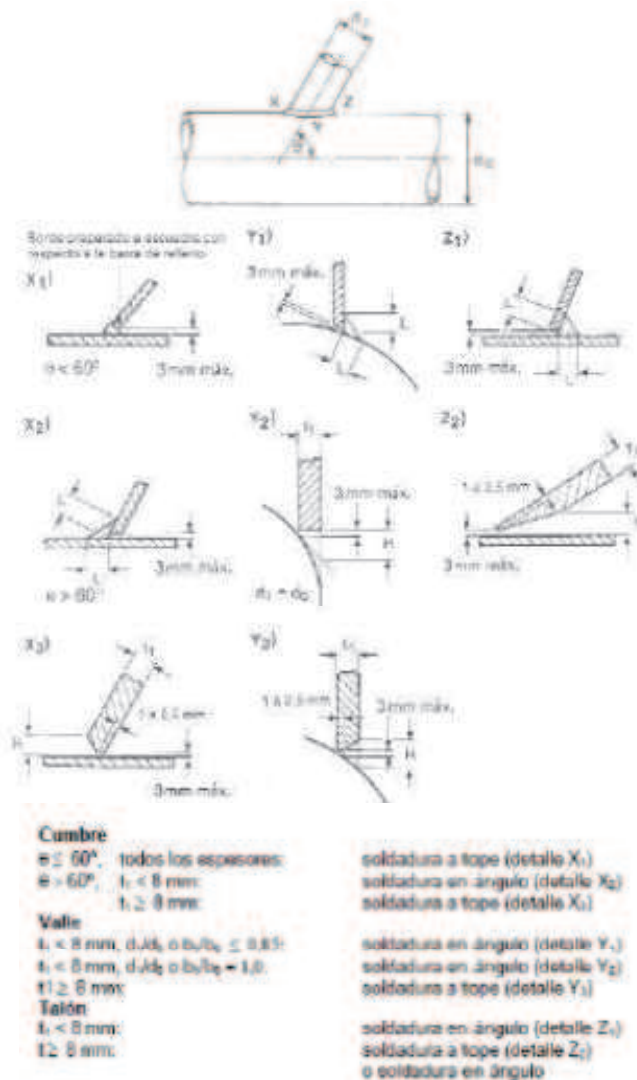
Soldaduras en ángulo y a tope.
